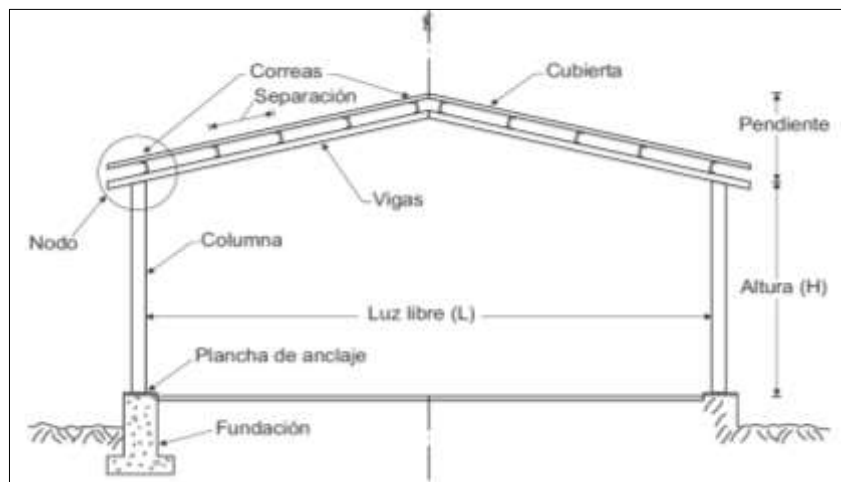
Componentes típicos de un galpón, Proyecto y Construcción de Galpones Modulares (Arna et al. 2014).
